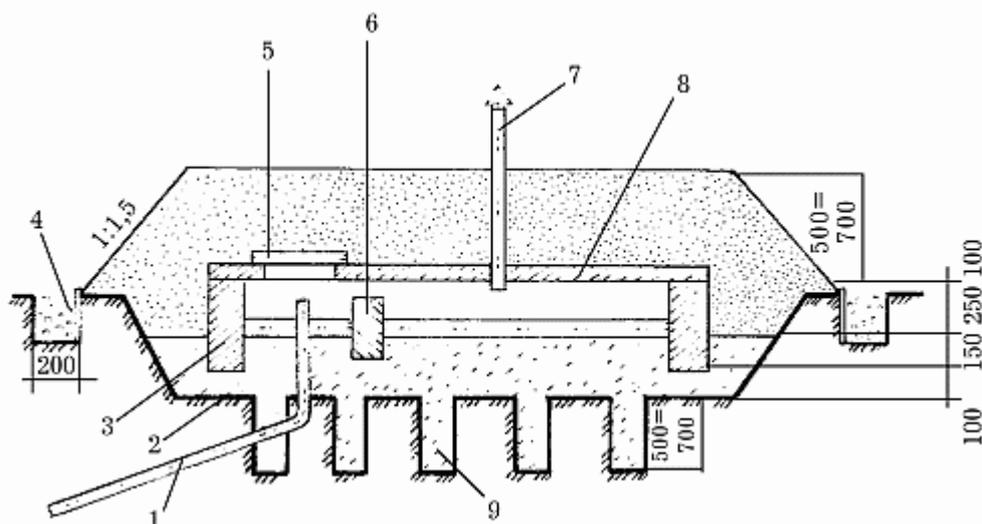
Фильтрующая кассета: 1 – подводящий трубопровод сточных вод; 2 – фильтрующее основание; 3 – опорные блоки из бетона или железобетона; 4 – дренажный лоток; 5 – деревянная крышка; 6 – струеотбойная стенка из блоков, установленных со щелями; 7 – вентиляционный стояк; 8 – железобетонная плита; 9 – колодцы (размеры даны в мм).
